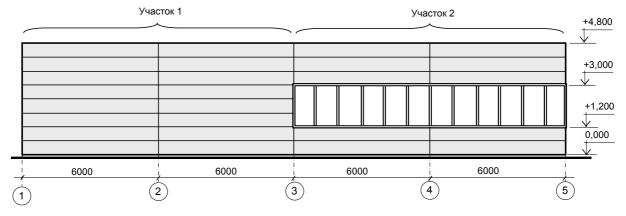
Схематичный фасад проектируемого здания (к примеру Е3)
